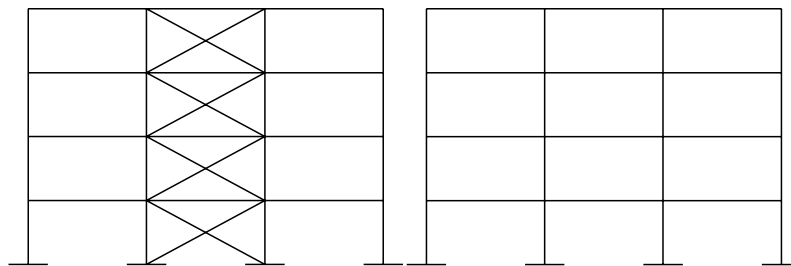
Pórtico arriostrado (puede ser traslacional si es muy flexible) y pórtico no arriostrado (puede ser intraslacional si es rígido horizontalmente)
